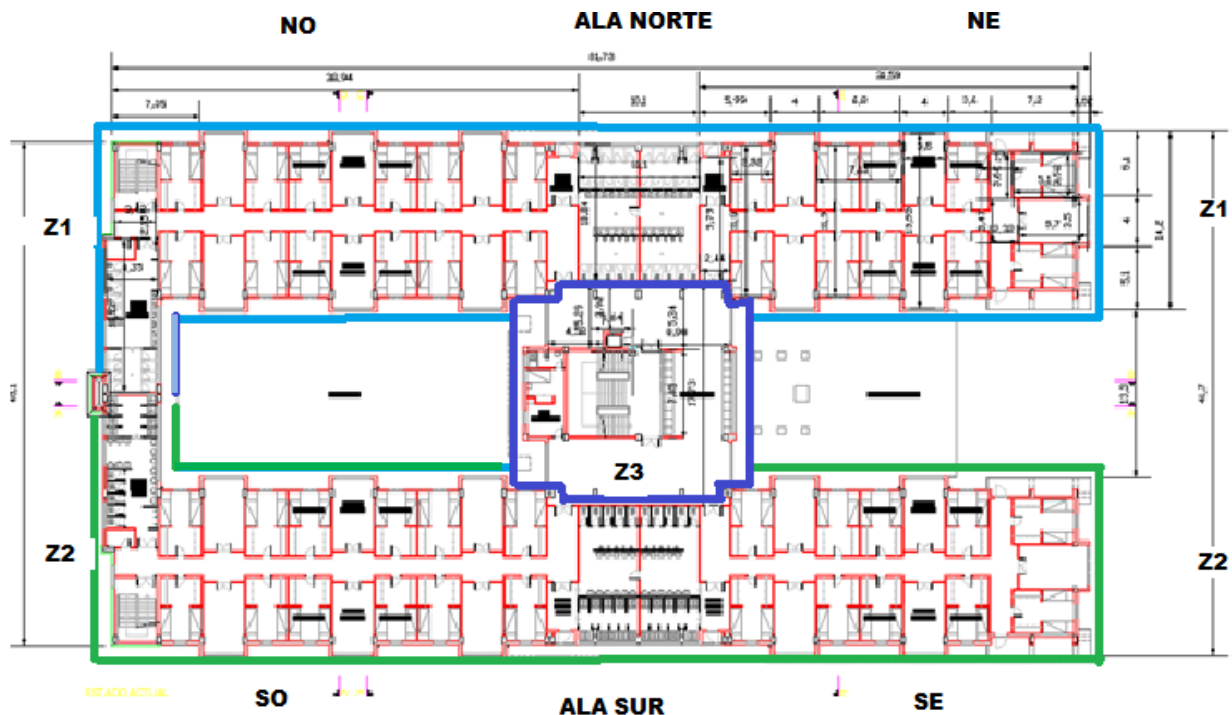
Plano de Zonas de División 1, 2 y 3 del Cuartel.
